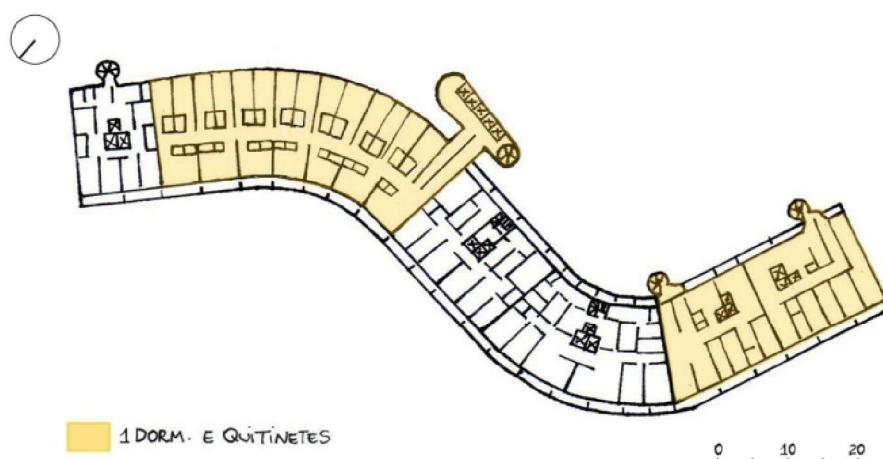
Reprodução da planta do Pavimento tipo do Edifício Copan.
